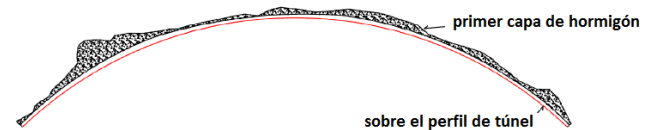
Primer capa de hormigón (Hjálmarsson, 2011)
